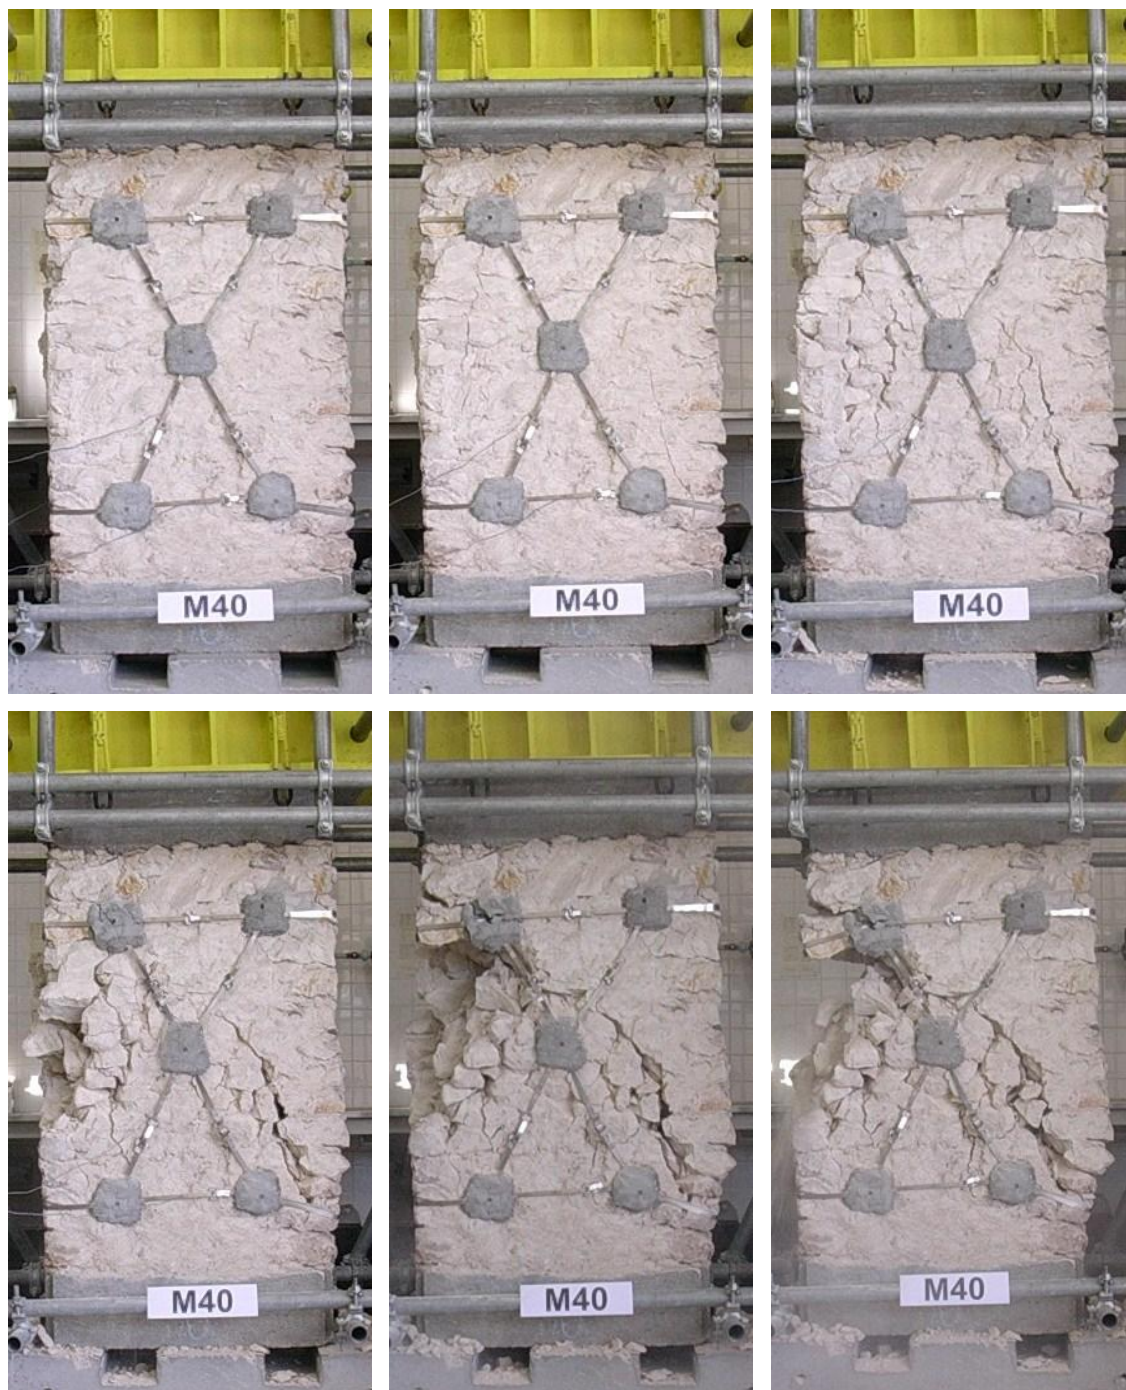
Ensaio de compressão axial sobre o murete M40
